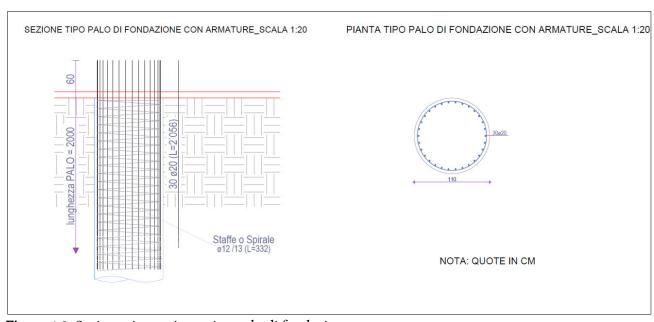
Sezione tipo e pianta tipo palo di fondazione con armature
